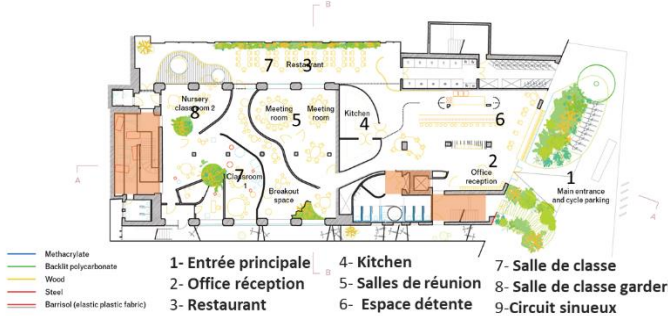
Analyse fonctionnelle Plan rez-de-chaussée
